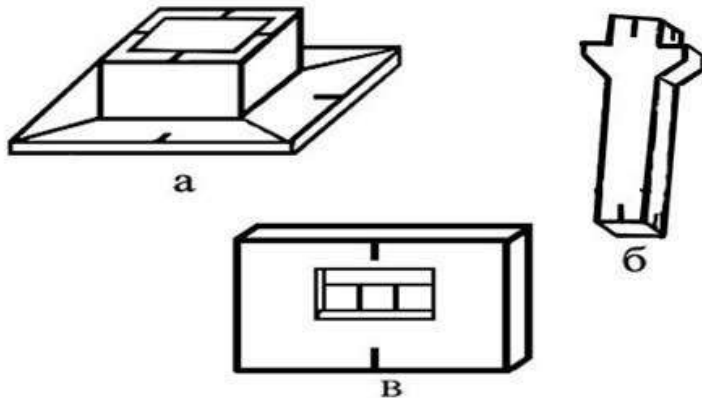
Приклади нанесення рисок осей симетрії на елементах будівельних конструкцій: а – фундаментний блок; б – залізобетонна колона; в – стінова панель.
